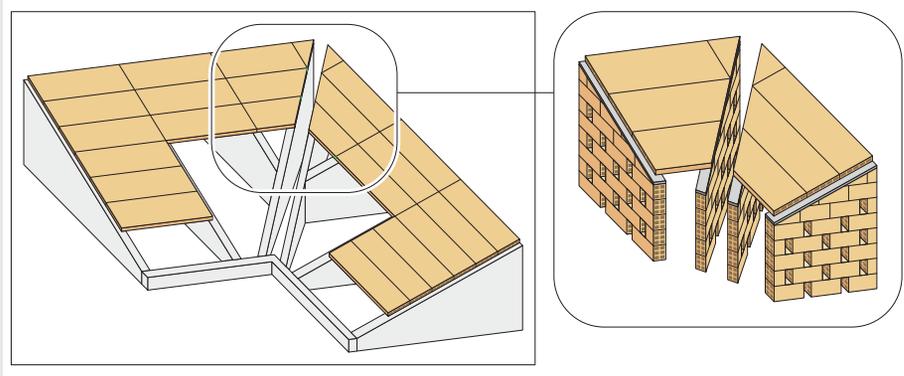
Apoyo del tablero sobre la limahoya en cubierta sobre forjado
